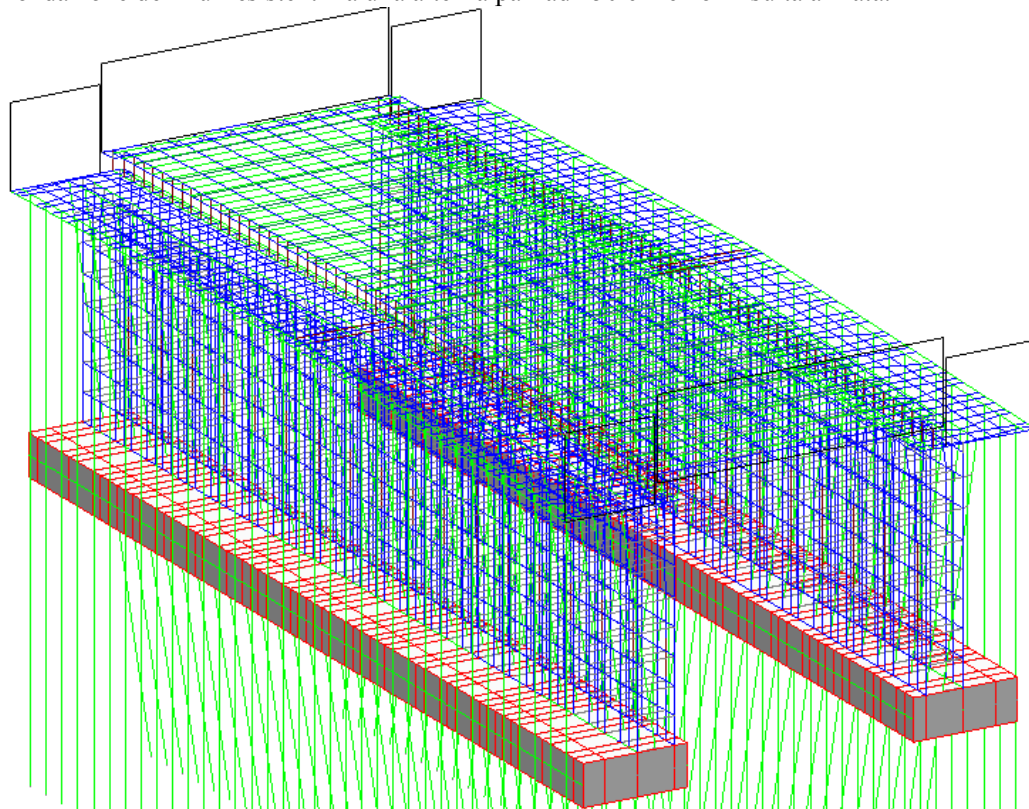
Modello 3D - Particolare delle fondazioni dei muri
